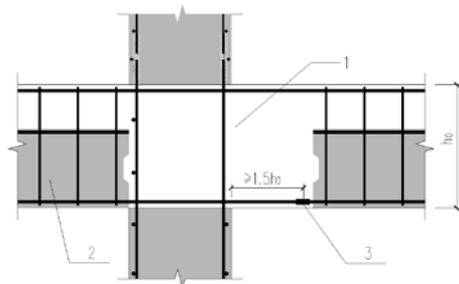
梁纵向钢筋在节点区外的现浇段内连接示意
